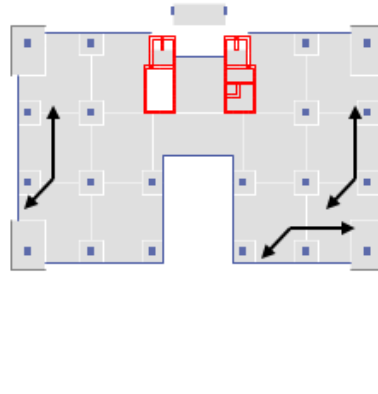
Esquema de ubicación de sensores en la Octava planta de la estructura. Instrumentación Tipo 1.
